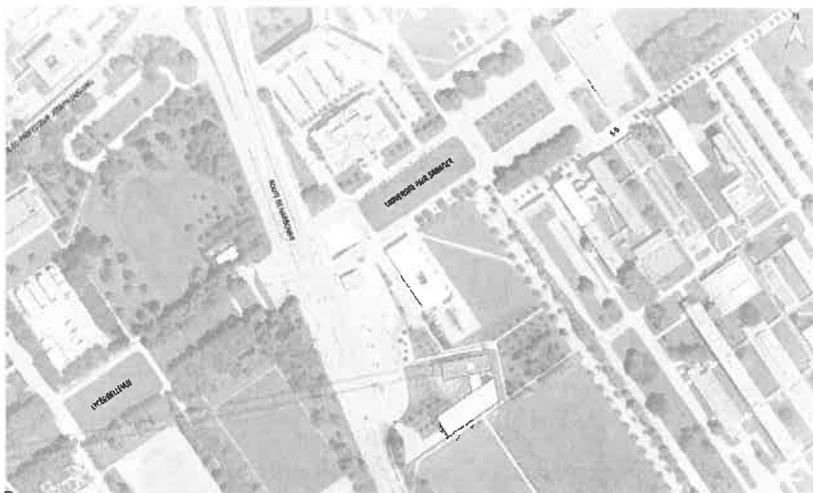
Plan de masse de la station UPS (source : Groupement POMA, 2018)
